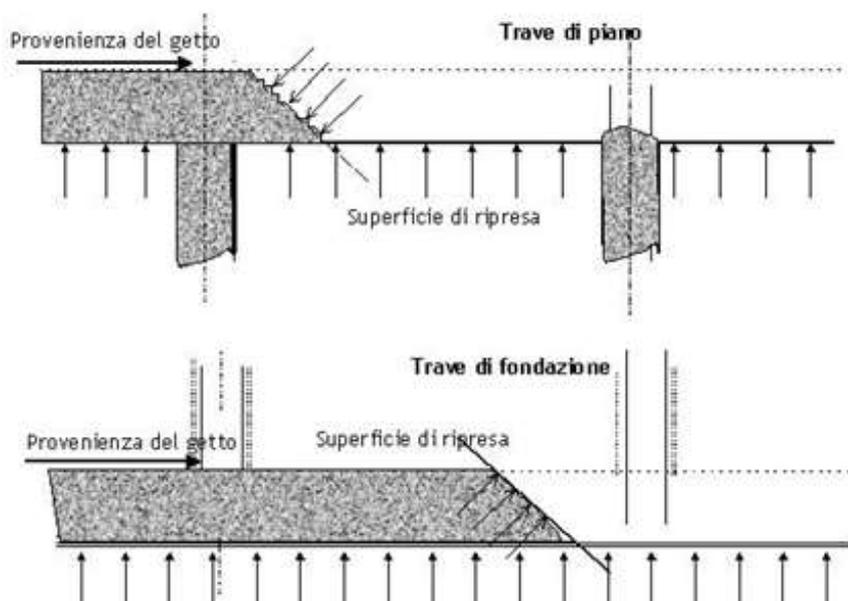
Ripresa di getto in travi di piano e di fondazione.
